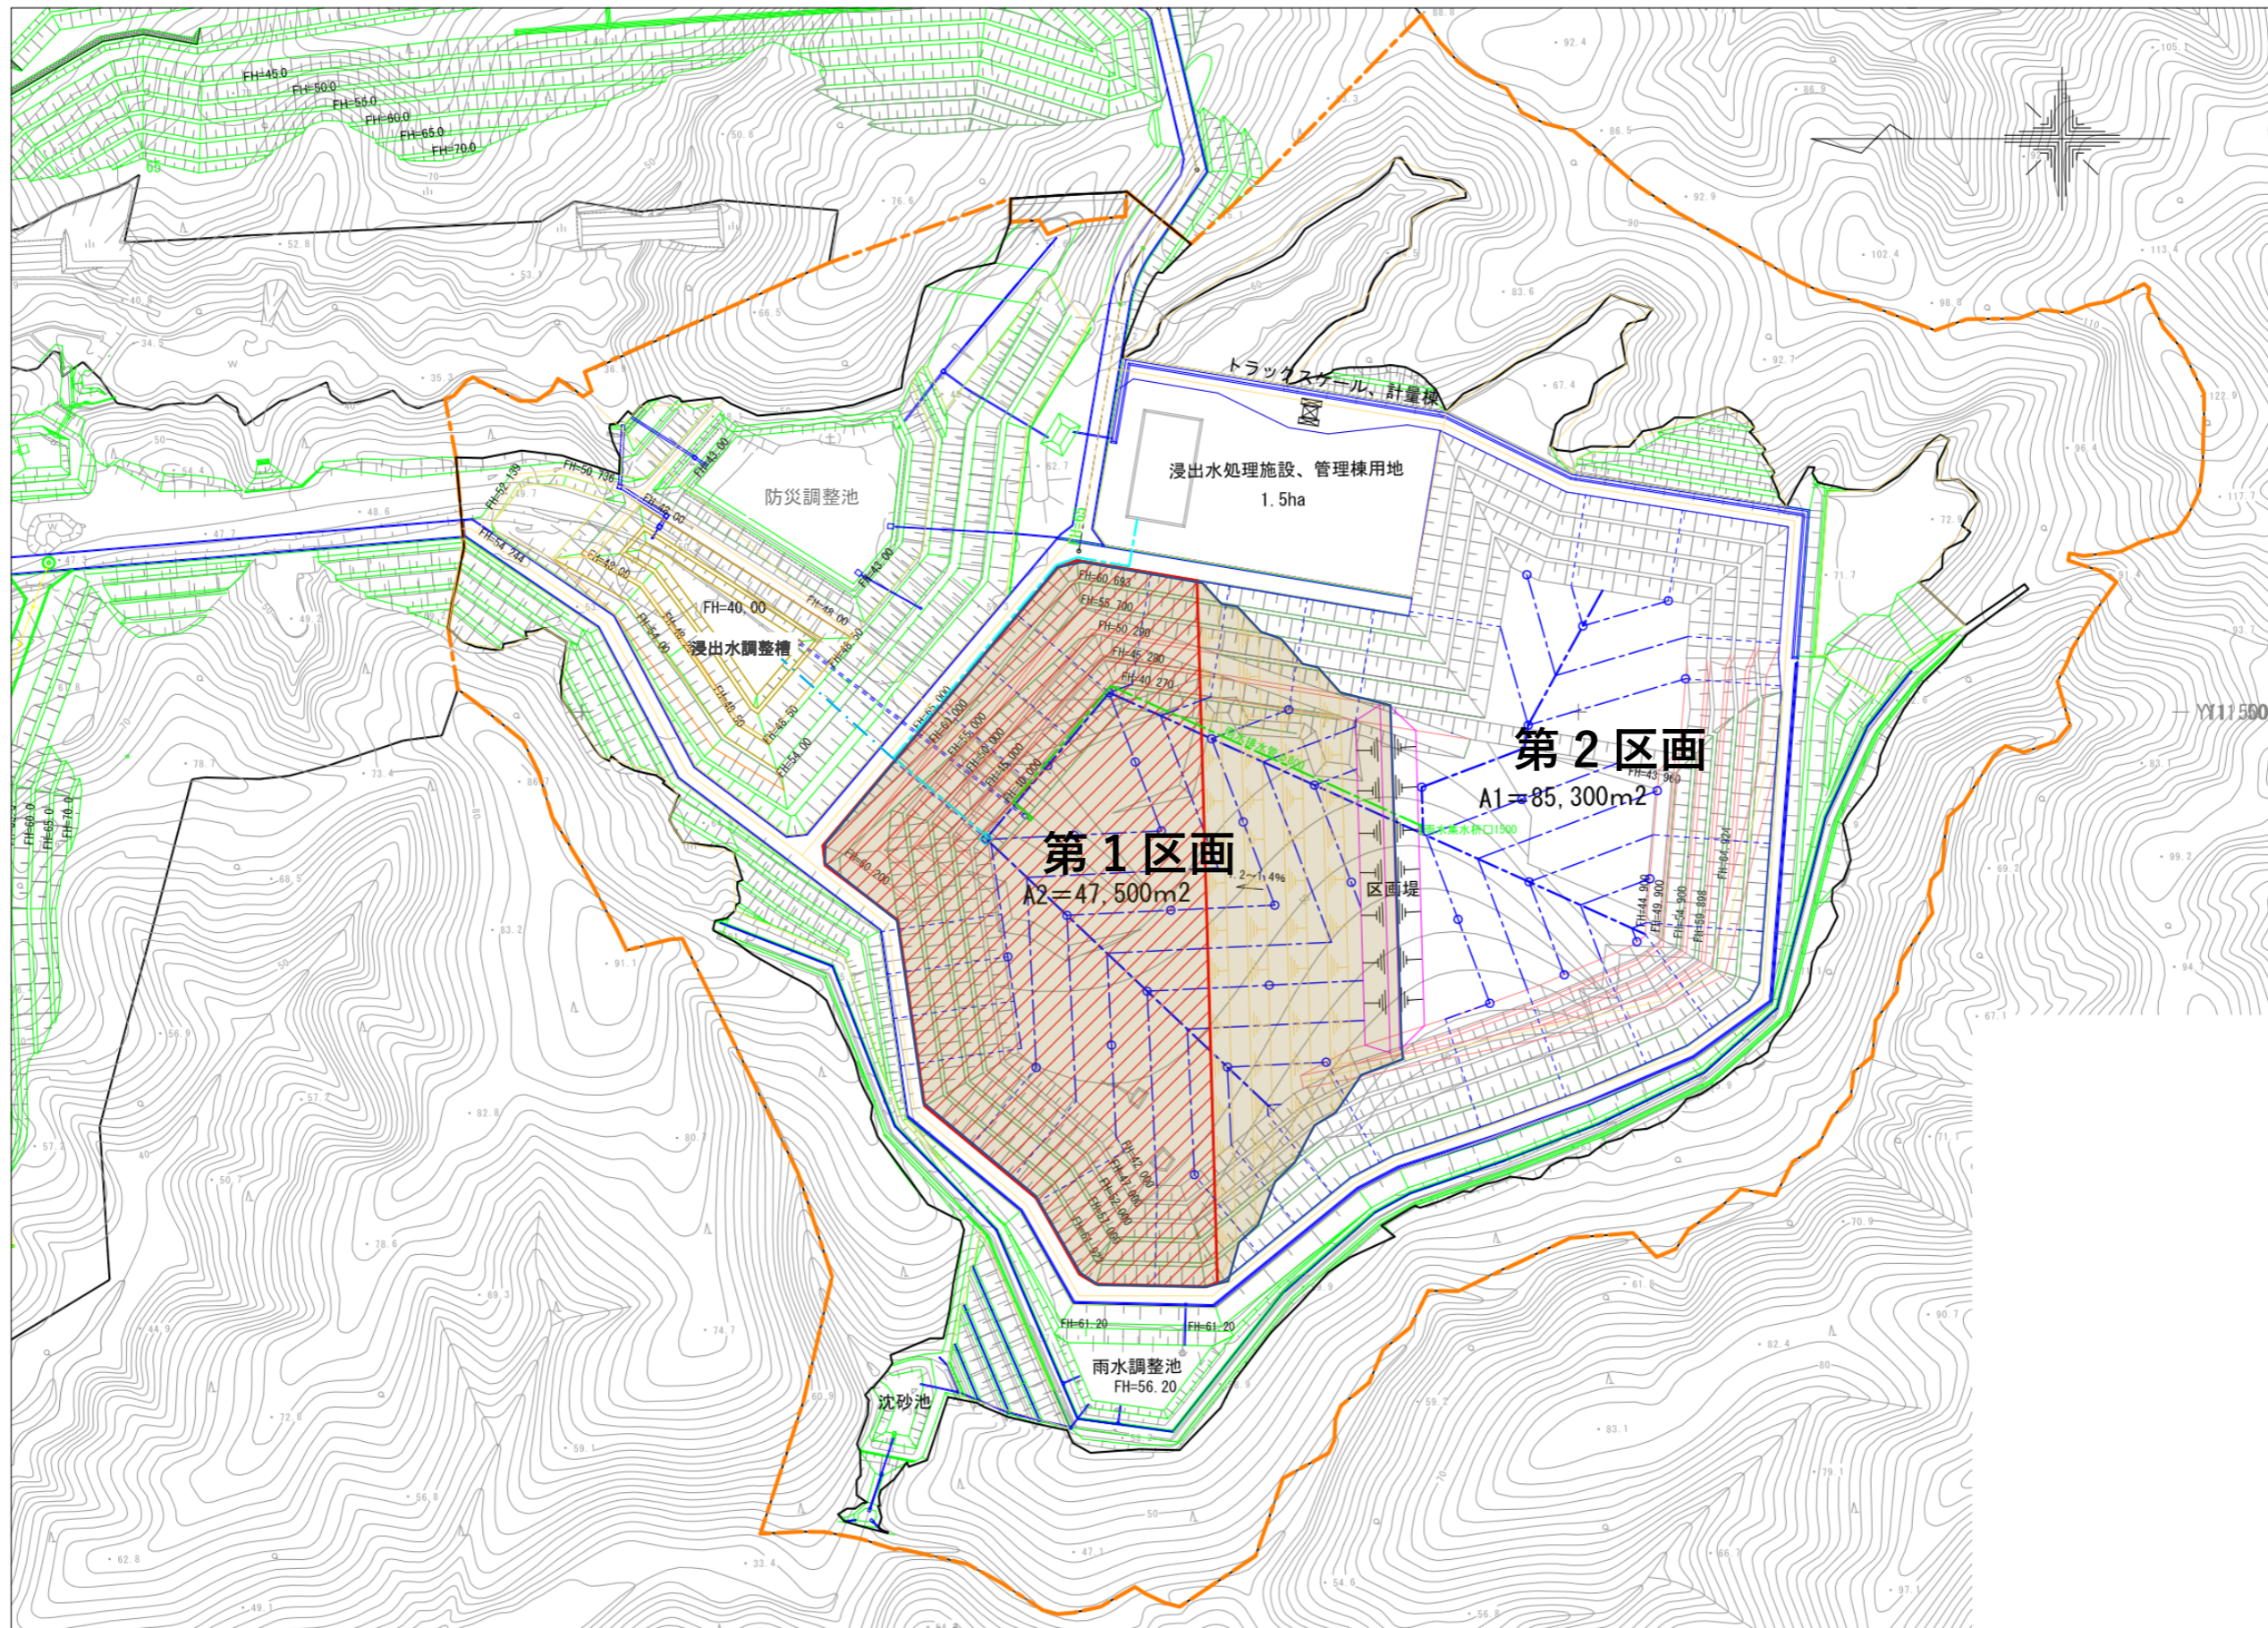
計画平面図 区画埋立第1段階埋立終了後
